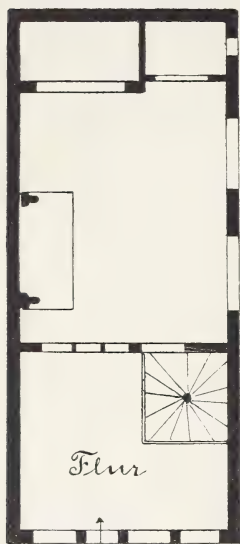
Grundriss eines Hauses (Amsterdam).
